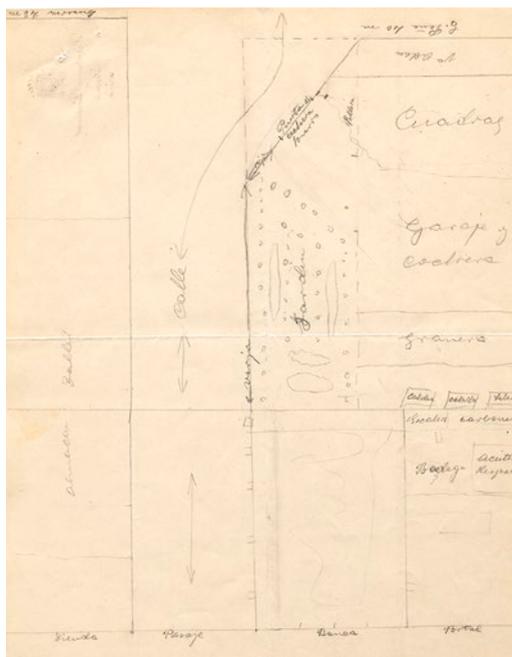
Croquis para la construcción de una vivienda. 1916. Planta baja<sup>36</sup>.
